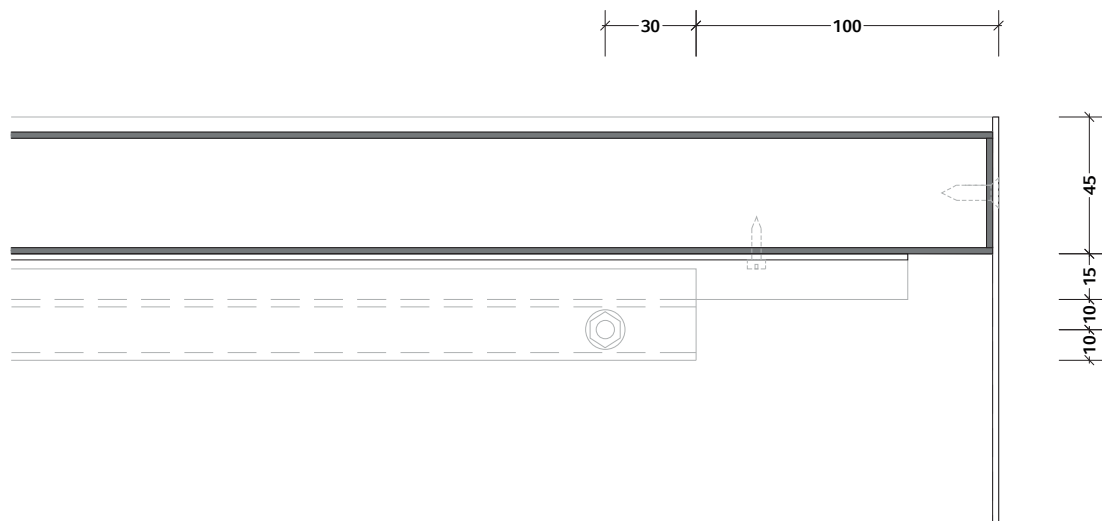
Gebäudekennzeichnung mit Standrohr Detail 01
